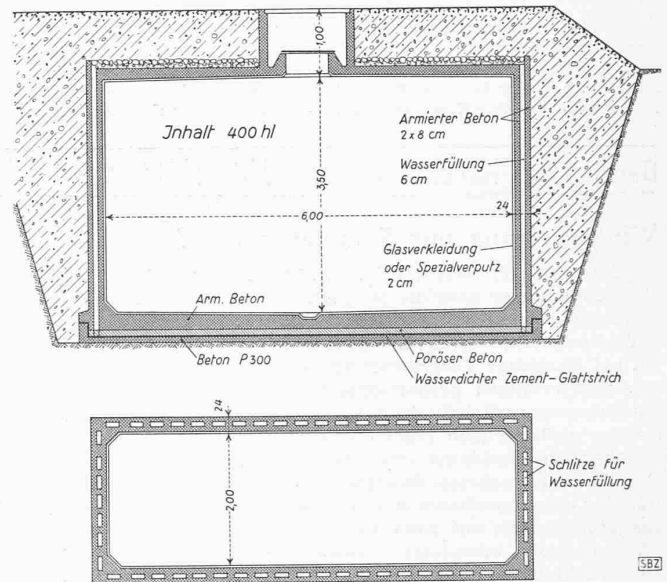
Borsari-Tank mit Wasserkammern in Eisenbeton für unterirdische Benzin-Lagerung in Zürich-Affoltern. — 1 : 100
